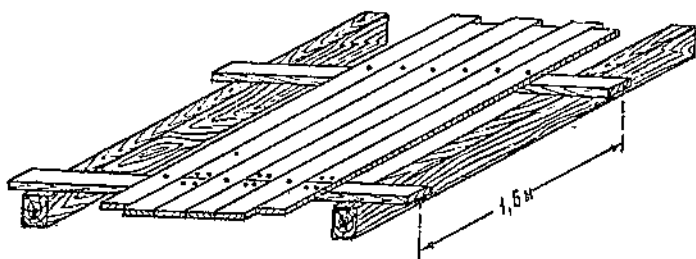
Однослойное деревянное основание под рулонную кровлю из обрезков досок.
